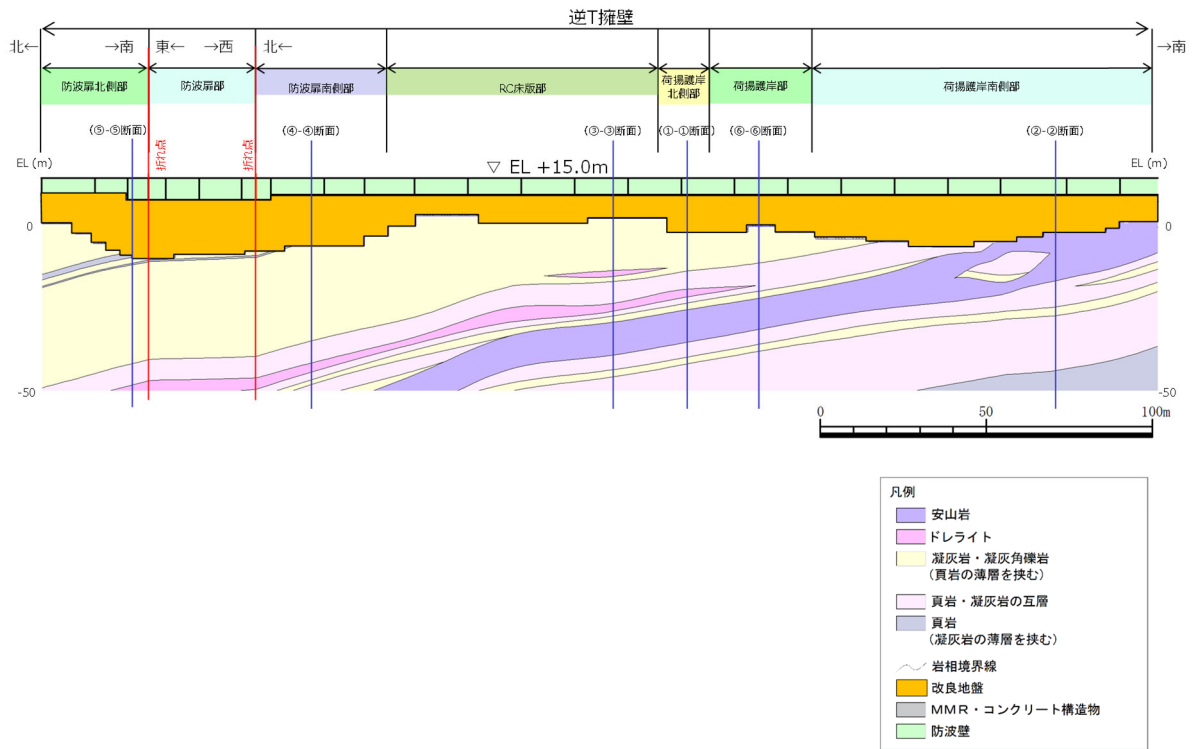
防波壁（逆 T 擁壁）の縦断面図
